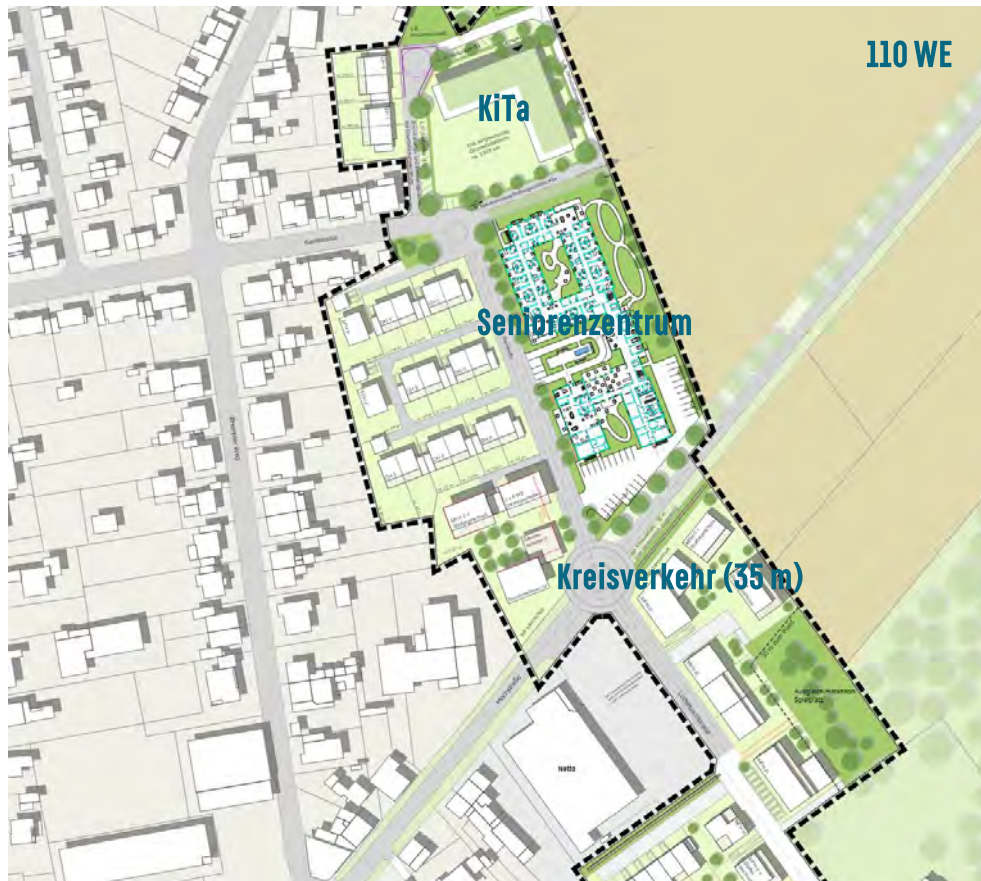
Plangebiet Kantstraße / Lütterbachstraße | Stand: Mai 2021 (Quelle: Gemeinde Niederkrüchten)
